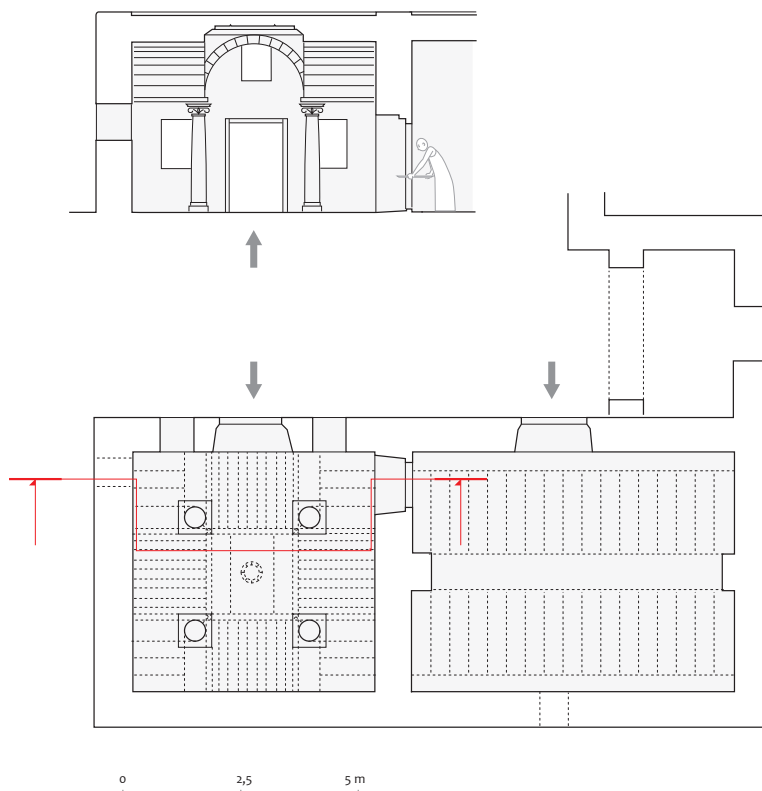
Shaqqā, Plan et coupe du *Ma'bed
